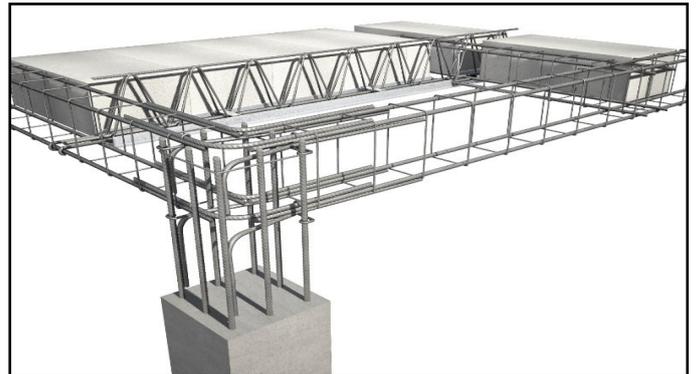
Пример армирования стыковочного узла вертикальных колонн и монолитного пояса
